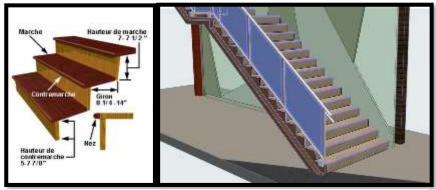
Détail escalier en béton pour le grand hall avec revêtement en bois
